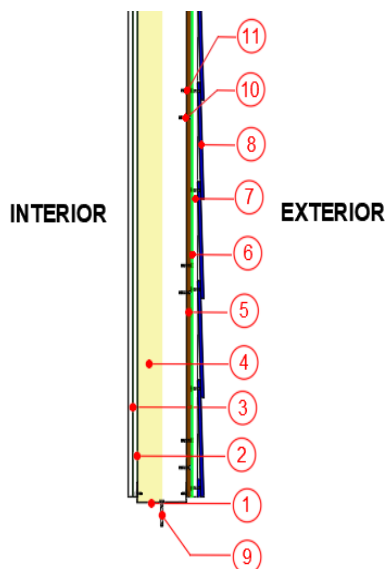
Planta del muro Tipo B, de construcción en Steel Framing.
